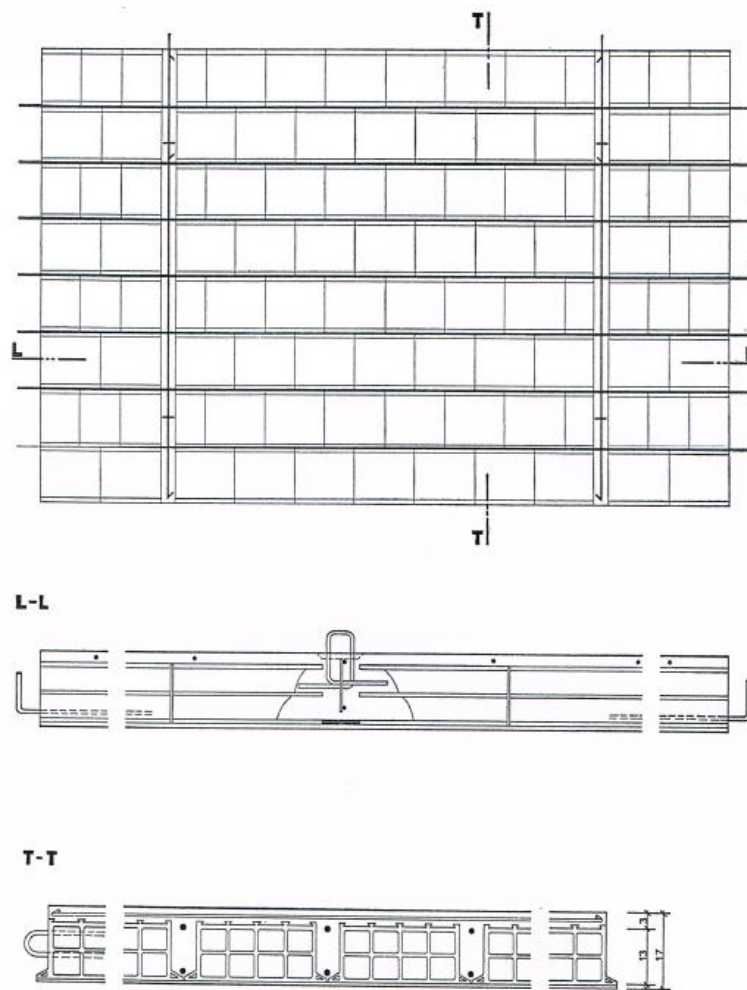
Painel de pavimento (LNEC, 1968).
